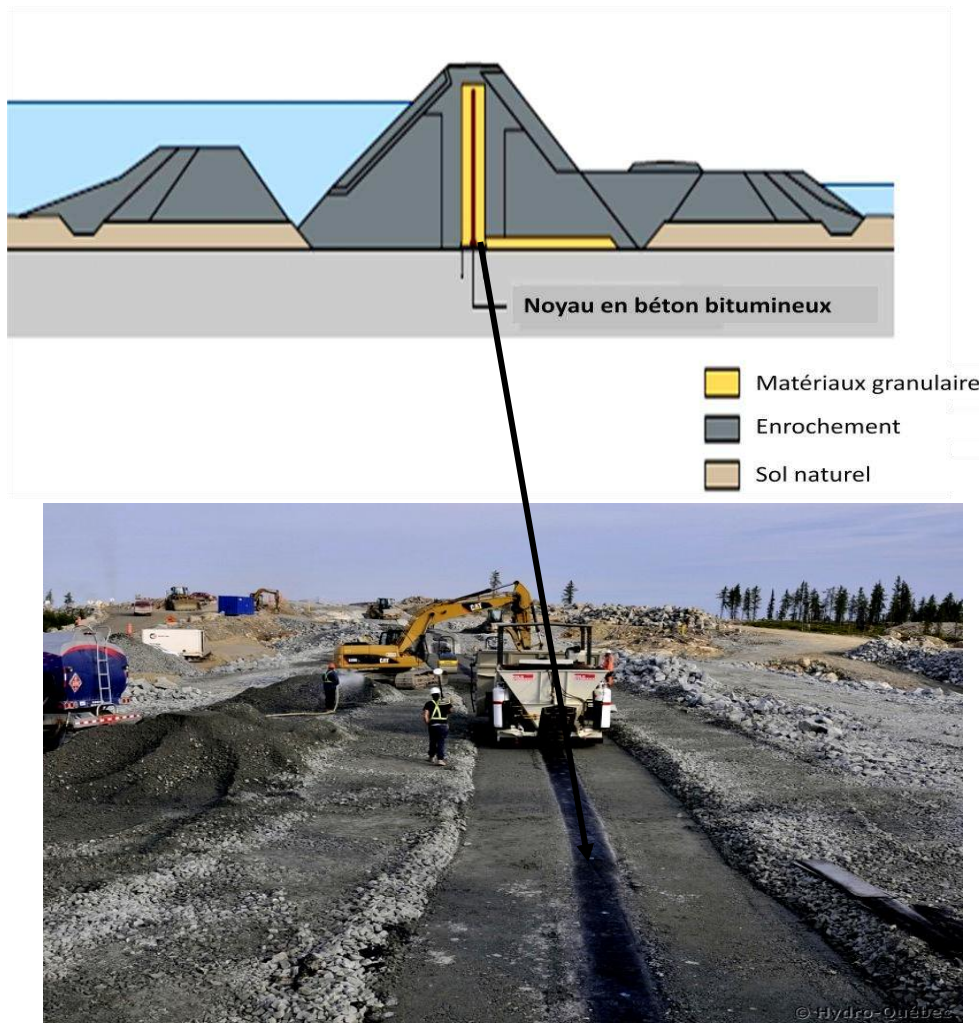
Noyau en béton bitumineux du barrage de Nemiscau, Canada ,1982 (Wang, 2009).
